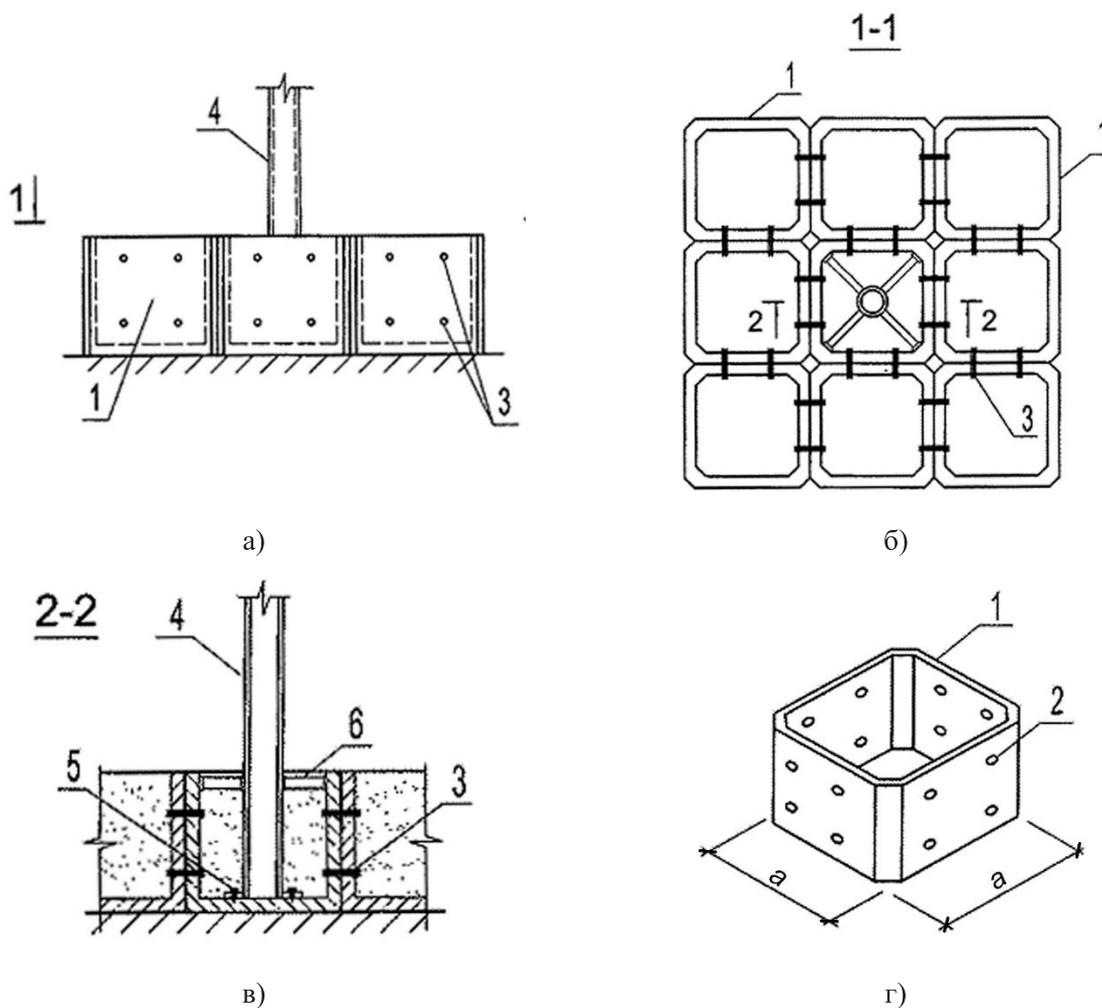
Сборно-разборный фундамент под опору: а – общий вид; б – вид сверху, разрез 1-1; в – разрез 2-2; г – аксонометрия железобетонного блока в виде полых квадратной призмы с размерами дна «а».
